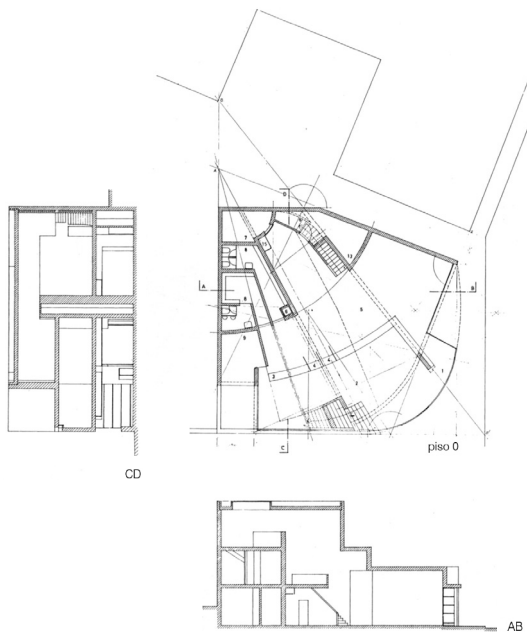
Banco de Oliveira de Azeméis, vista exterior, planta principal e cortes, Álvaro Siza.
